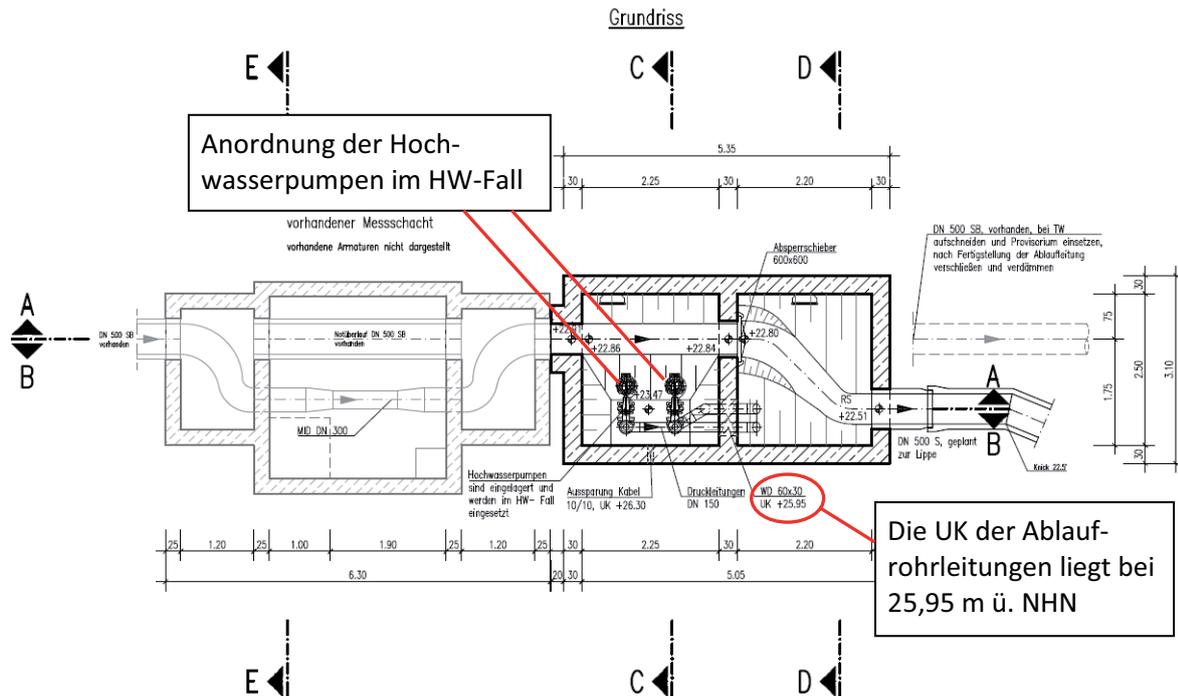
Grundriss des im Jahr 2009 erbauten Hochwasserpumpwerks der Kläranlage Hünxe [Dahlem, 2011]
